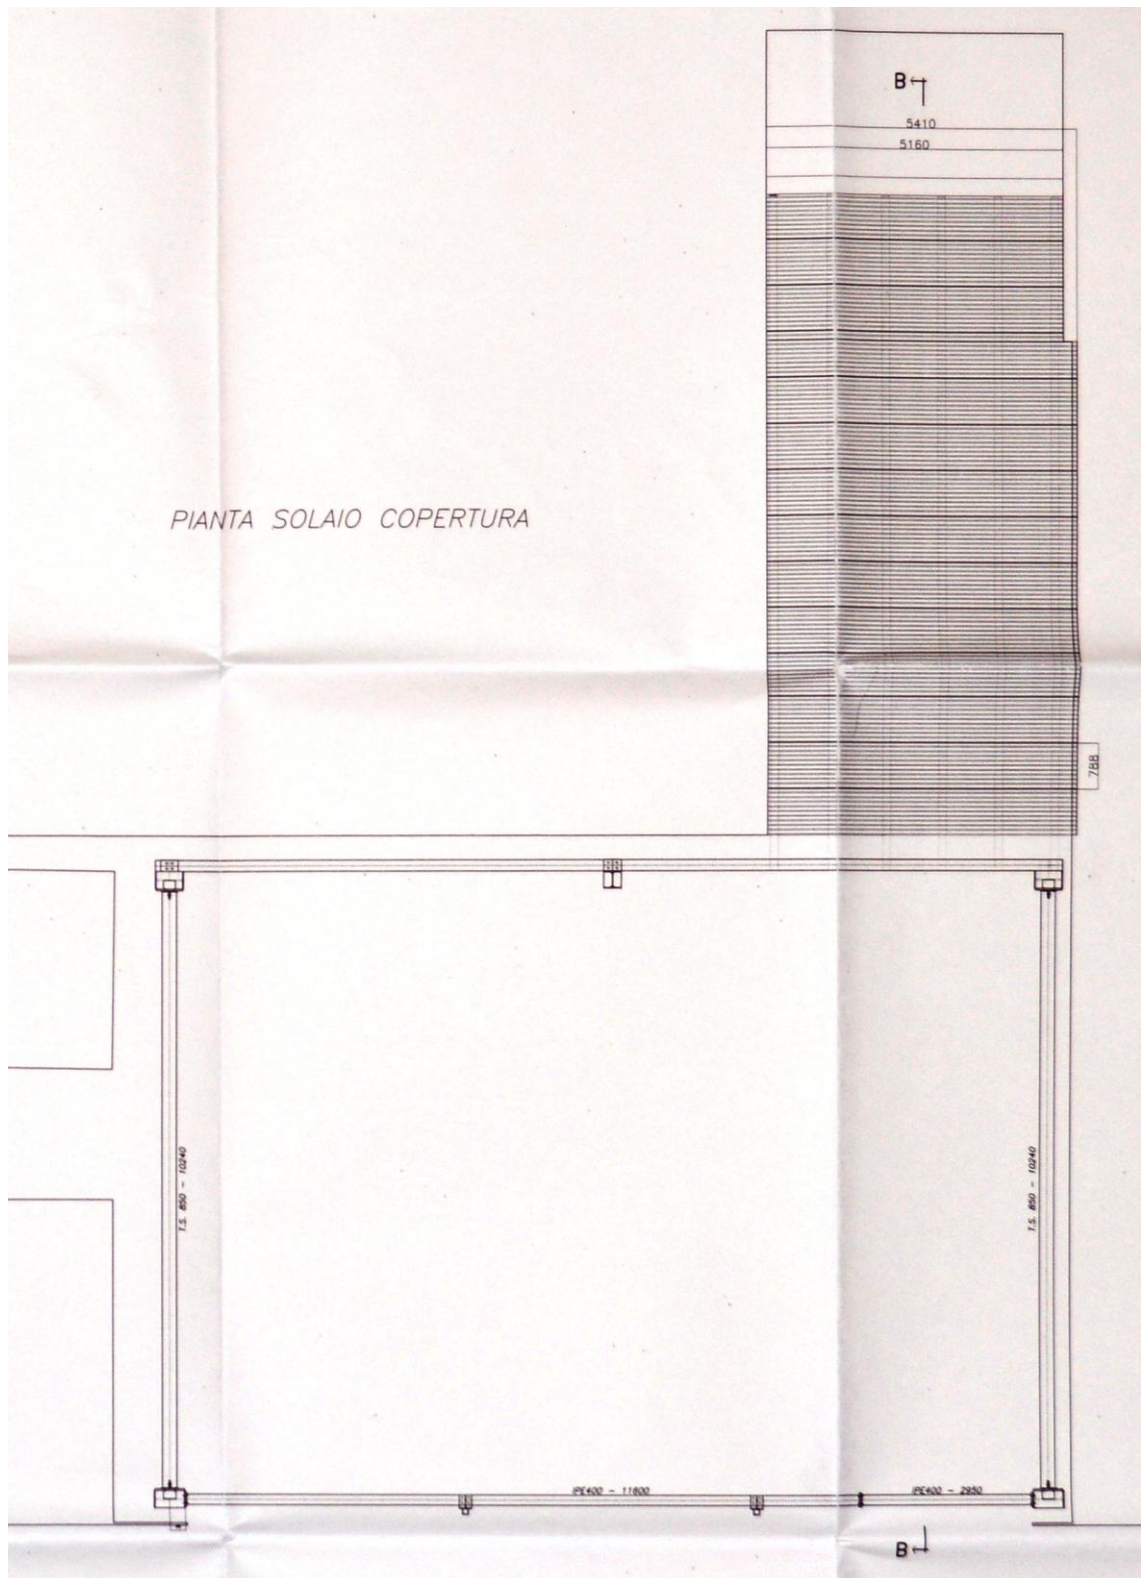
Particolare di A.2003.a.us.b.T06 - Pianta lamiere grecate - Pianta copertura
